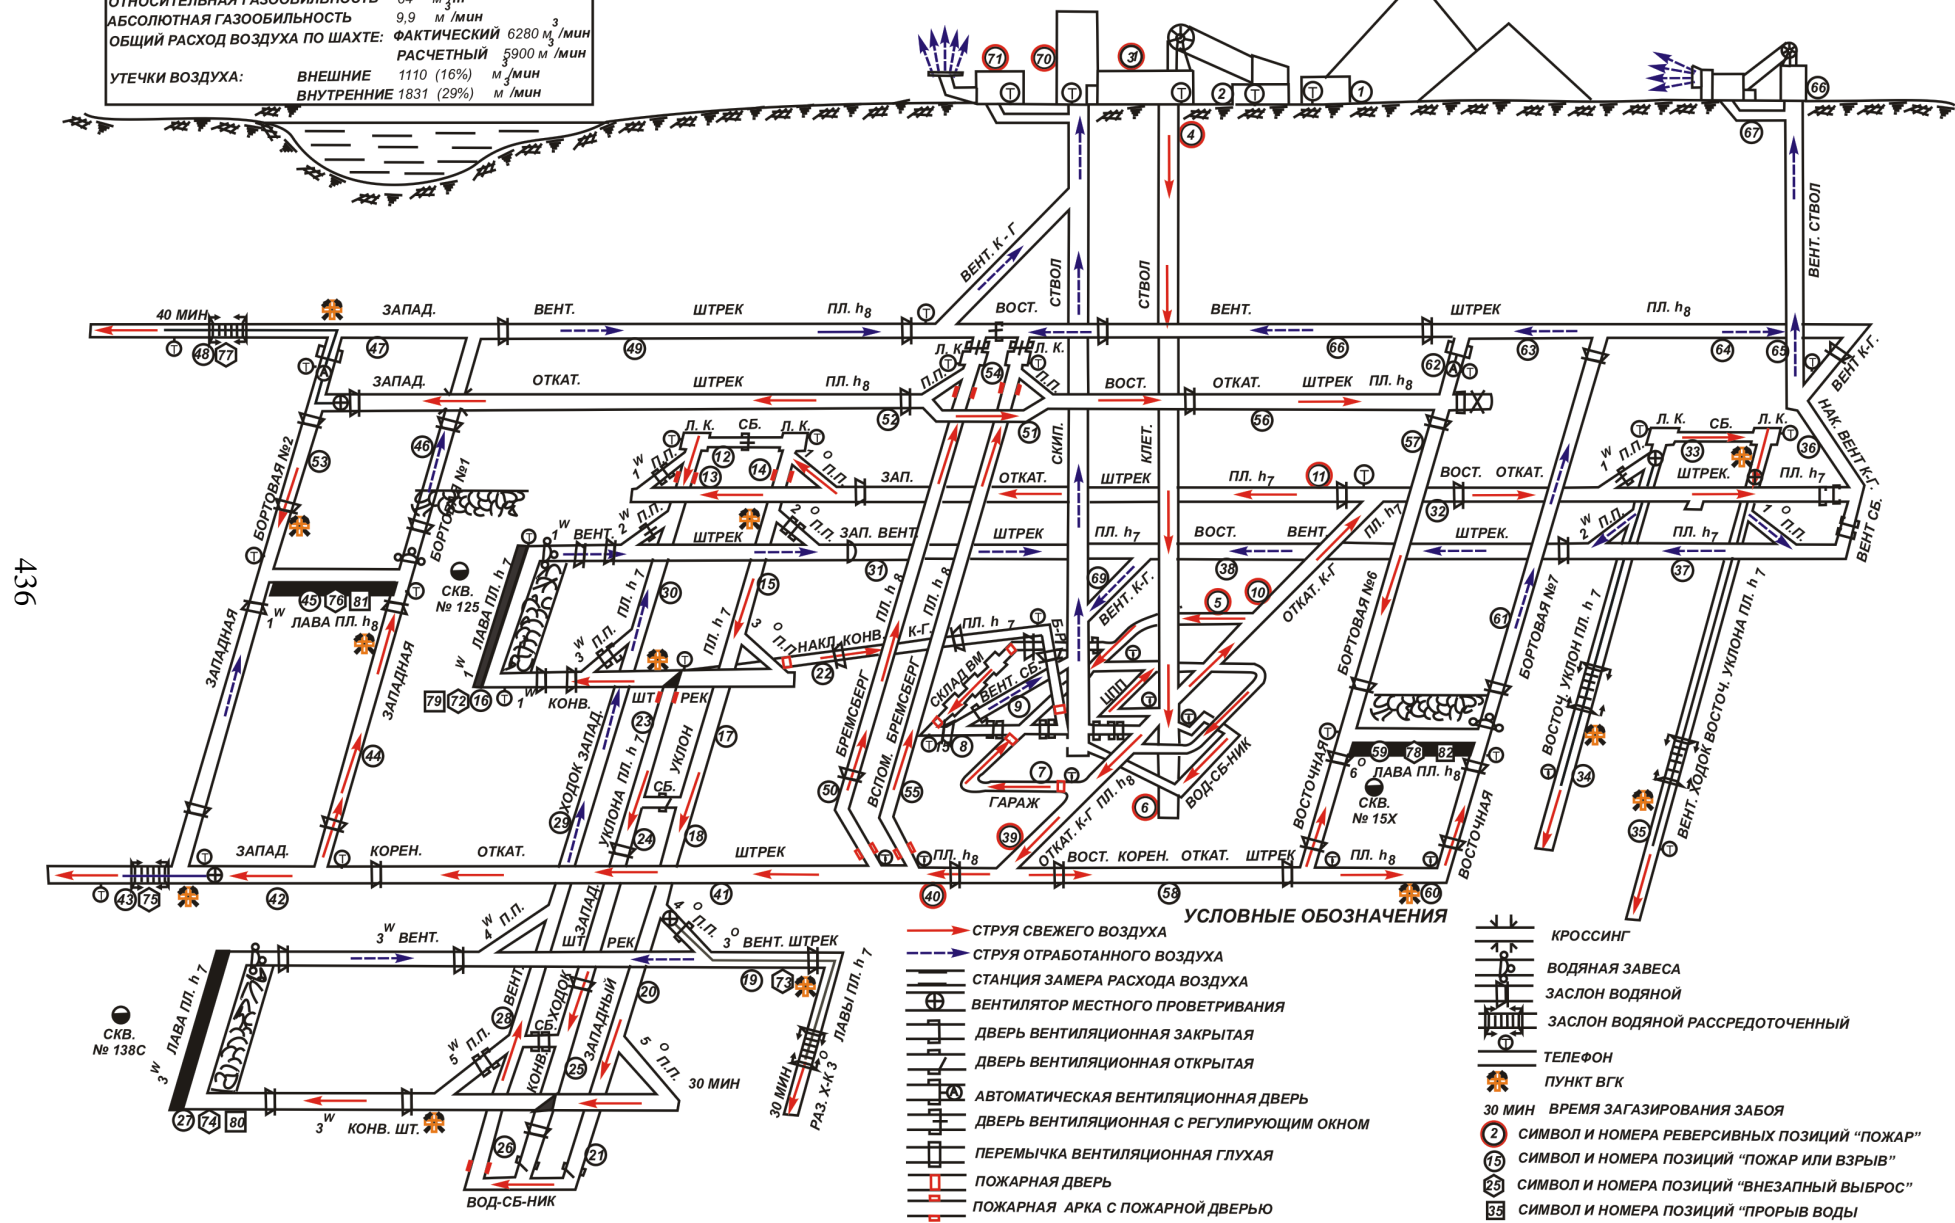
Схема вентиляции шахты к плану ликвидации аварий
